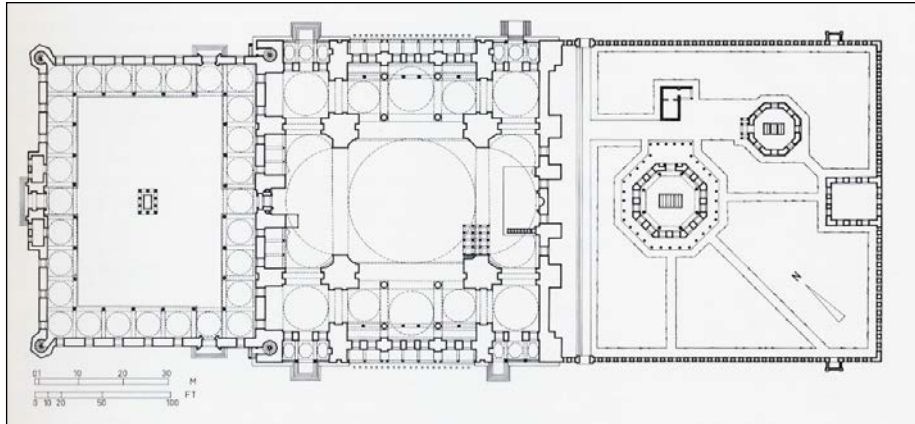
Süleymaniye Moschee, Grundriss
